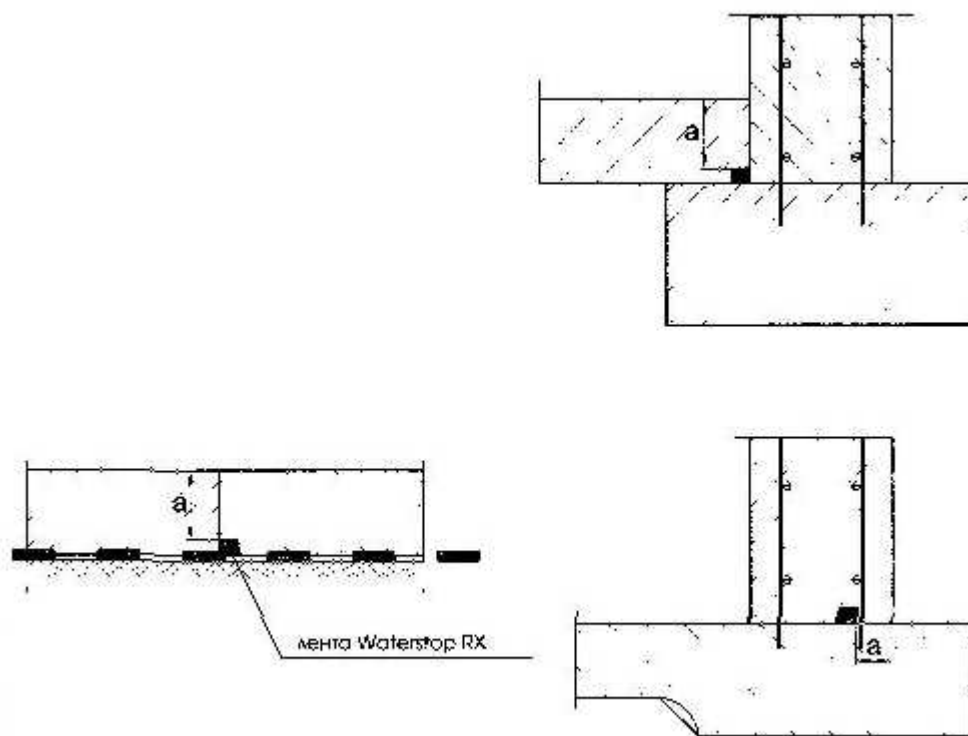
Типичные применения шнуров (лент) в соединениях железобетонных элементов с двойной арматурой
